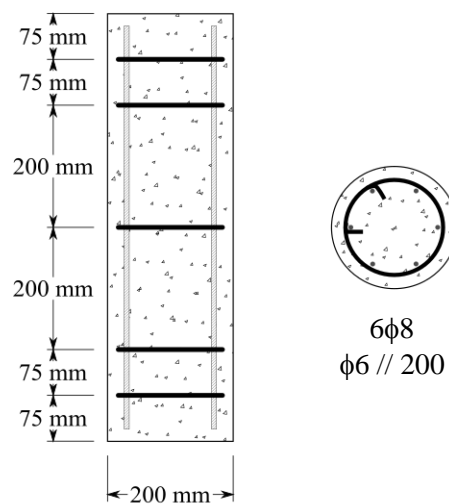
Pormenorização das armaduras dos modelos de betão armado
